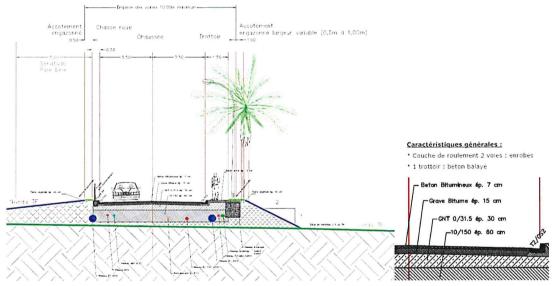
profil en travers type de la voie de liaison (source : Suez Consulting)
